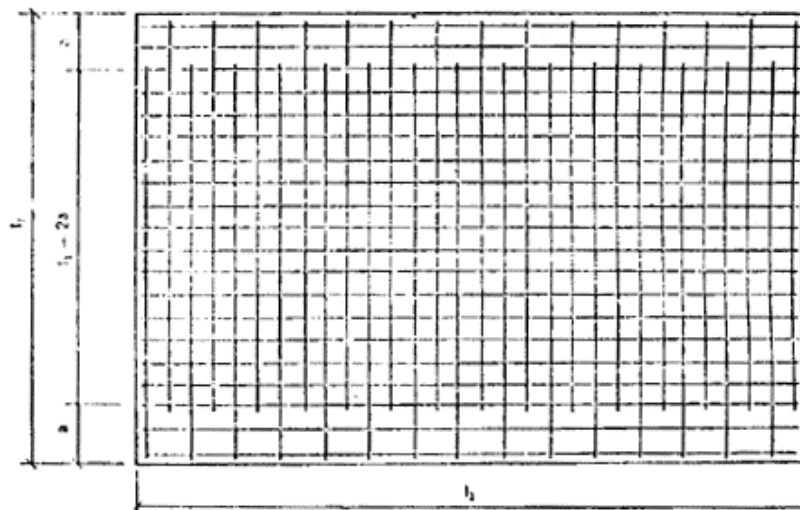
Схема к примеру расчета сборной плиты перекрытия, опертой по контуру
